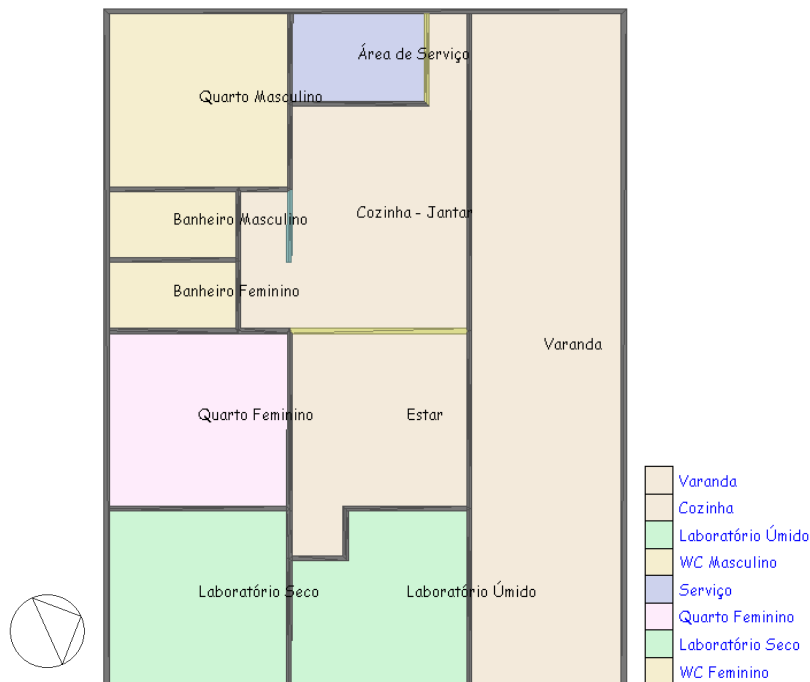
Planta baixa do modelo simulado no Design Builder.
